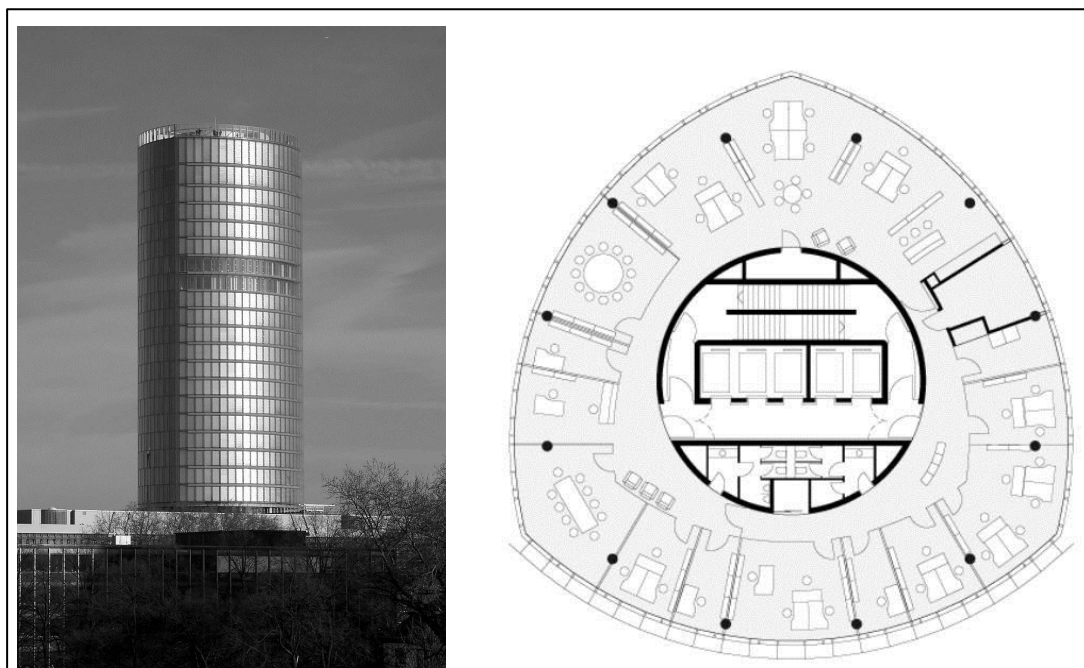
Außenansicht des „KölnTriangle“ sowie Grundriss einer Etage des Gebäudes
